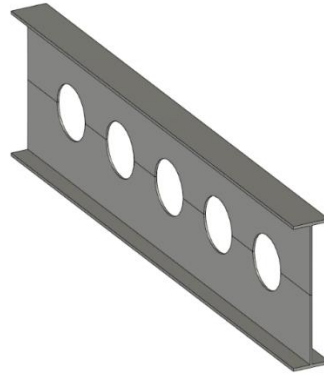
Vista 3D de la viga BOYD formada por el perfil IPE 500.
